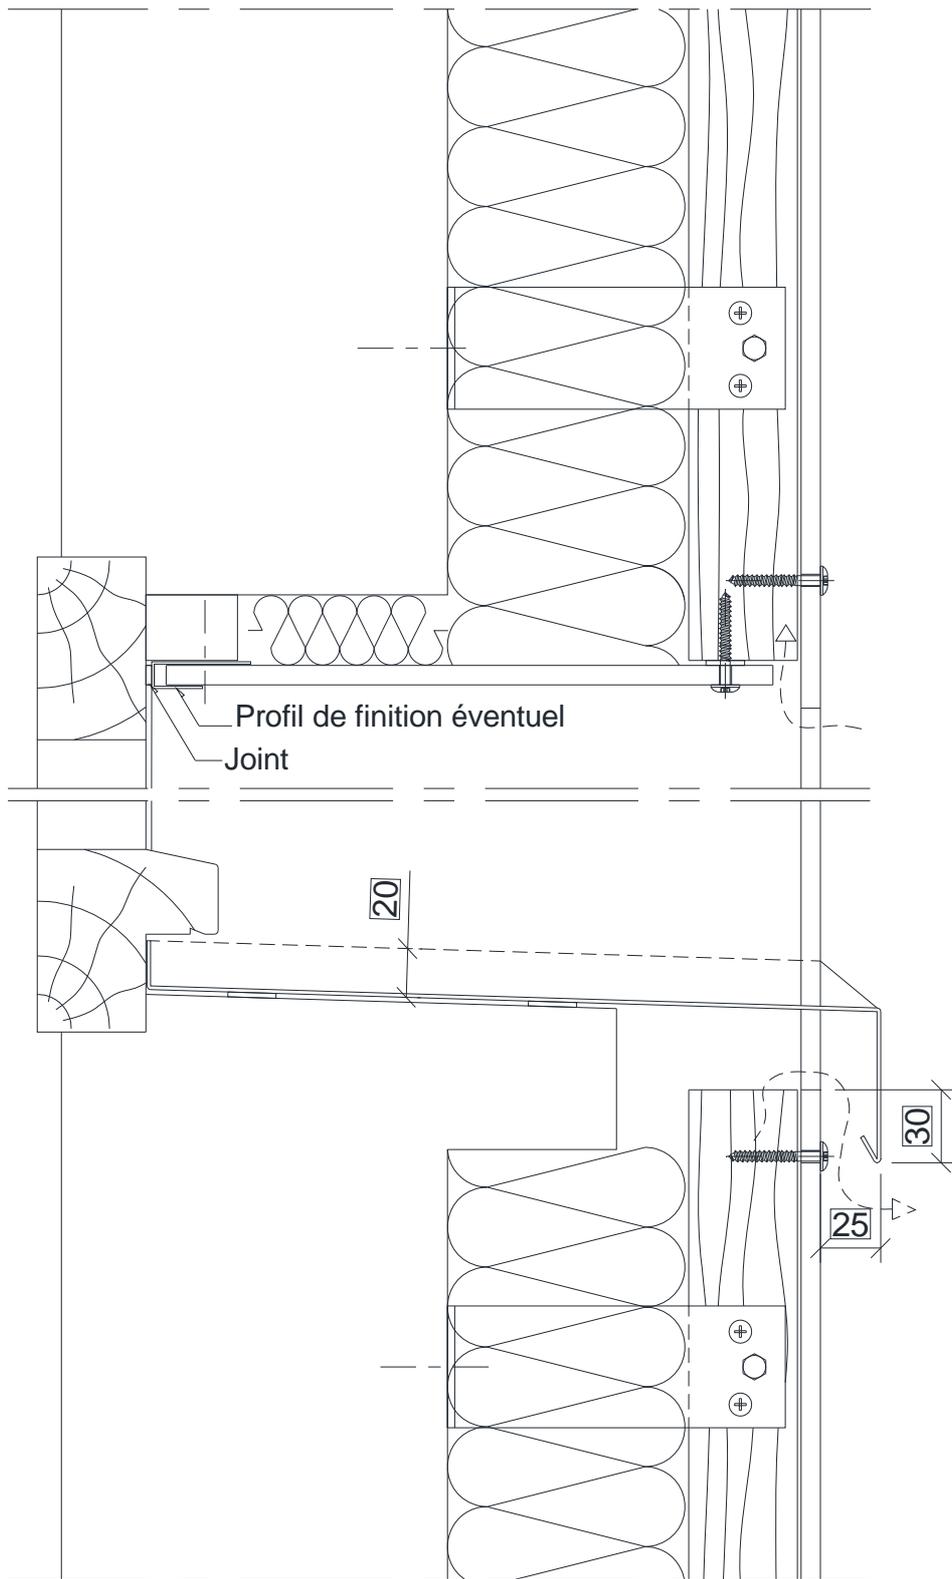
Encadrement de baie avec isolation complémentaire – Coupe verticale - Pose en bardage
